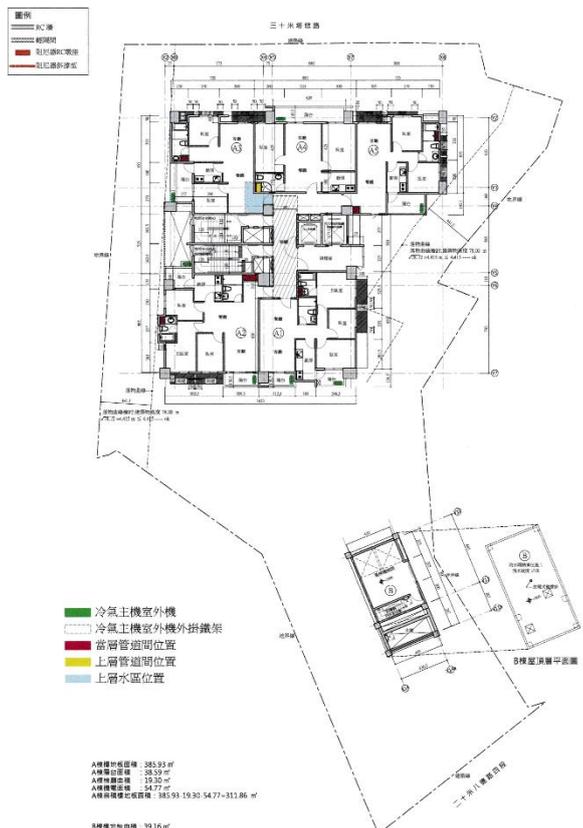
十八層平面圖、B 棟屋突三層平面圖(S : 1/300)
